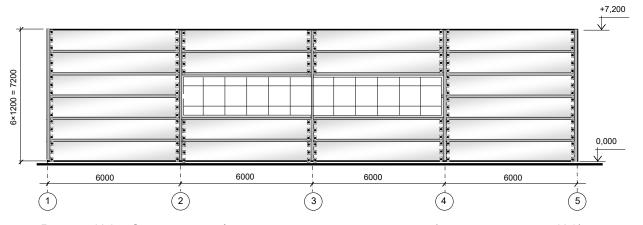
Схематичный фасад производственного здания (к примеру расчета И.3)
